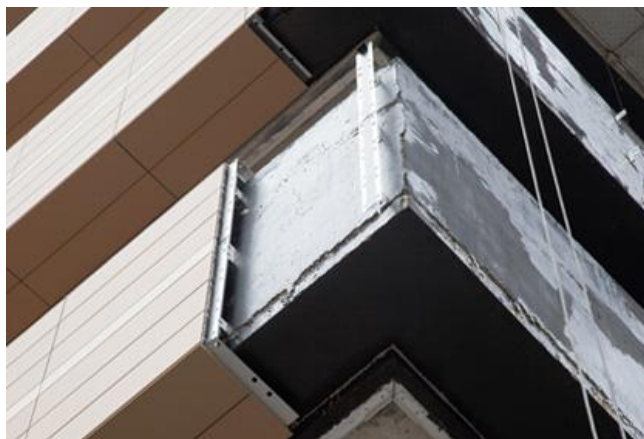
y 184. Edifício Jurubatuba, en São Paulo, con más de 40% de fachada transparente y fachada ventilada opaca. Fuente: Gail cerámica (2014).
